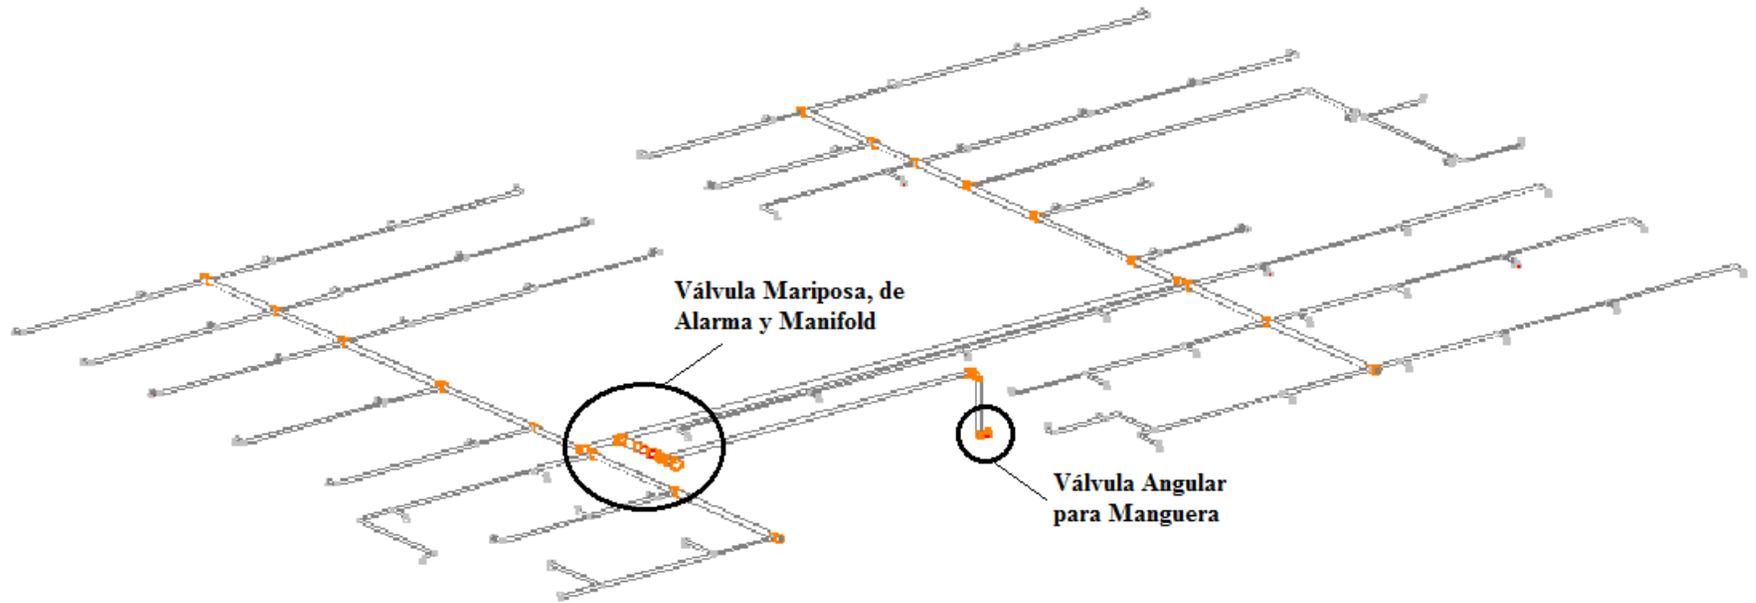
Vista Detallada de la Red de Incendios de la Planta Baja.
